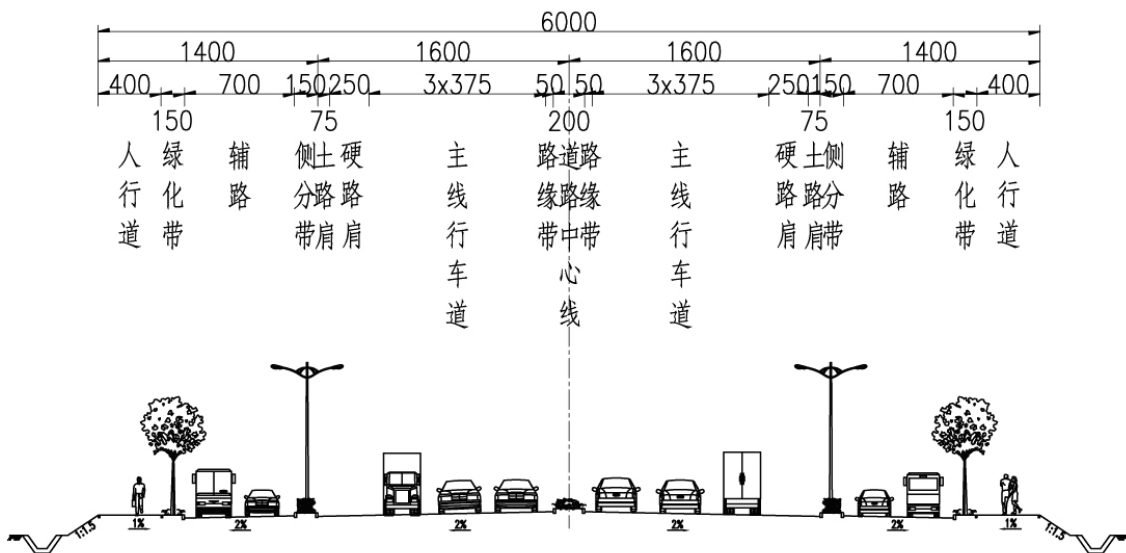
路基路段标路基准横断面布置图（尺寸单位：厘米）
